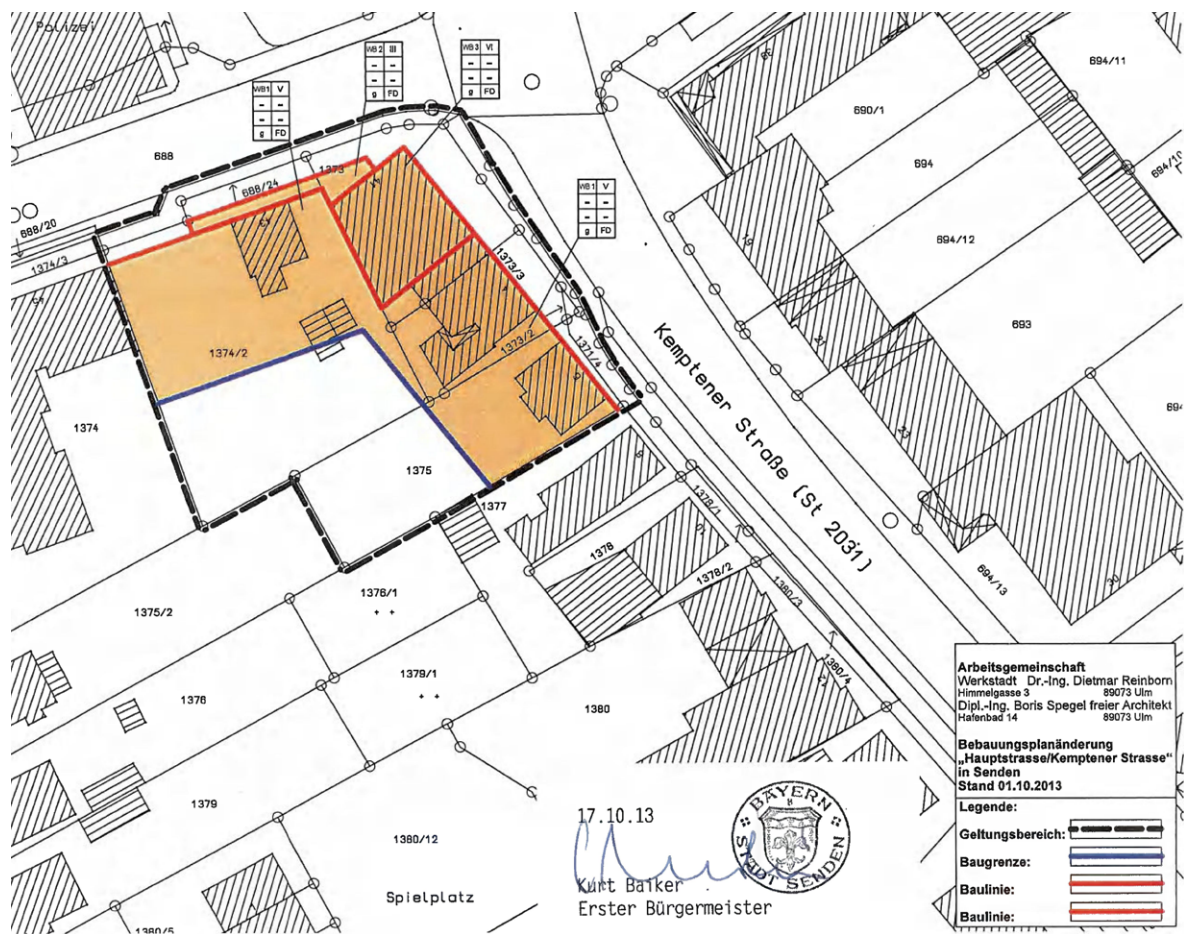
Bebauungsplan „Hauptstraße / Kemptener Straße“
